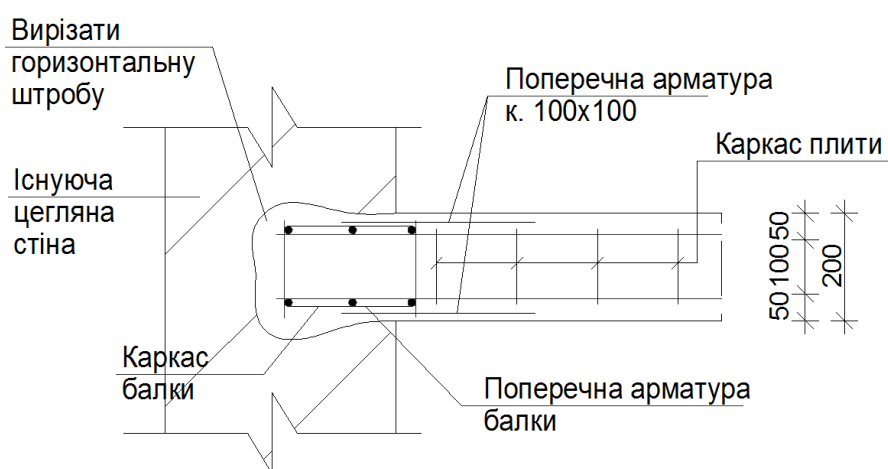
Приклад влаштування монолітної залізобетонної балки в існуючій цегляній стіні при бетонуванні перекриття з вклядишем
